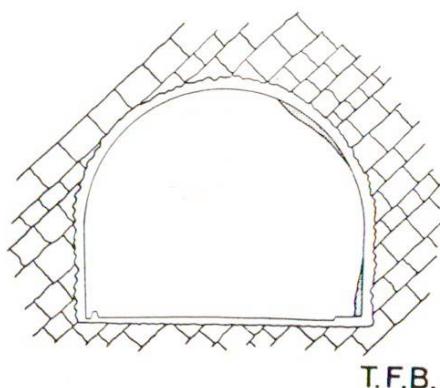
Tunnel bétonné. Glace en plaque, sans danger pour la circulation
